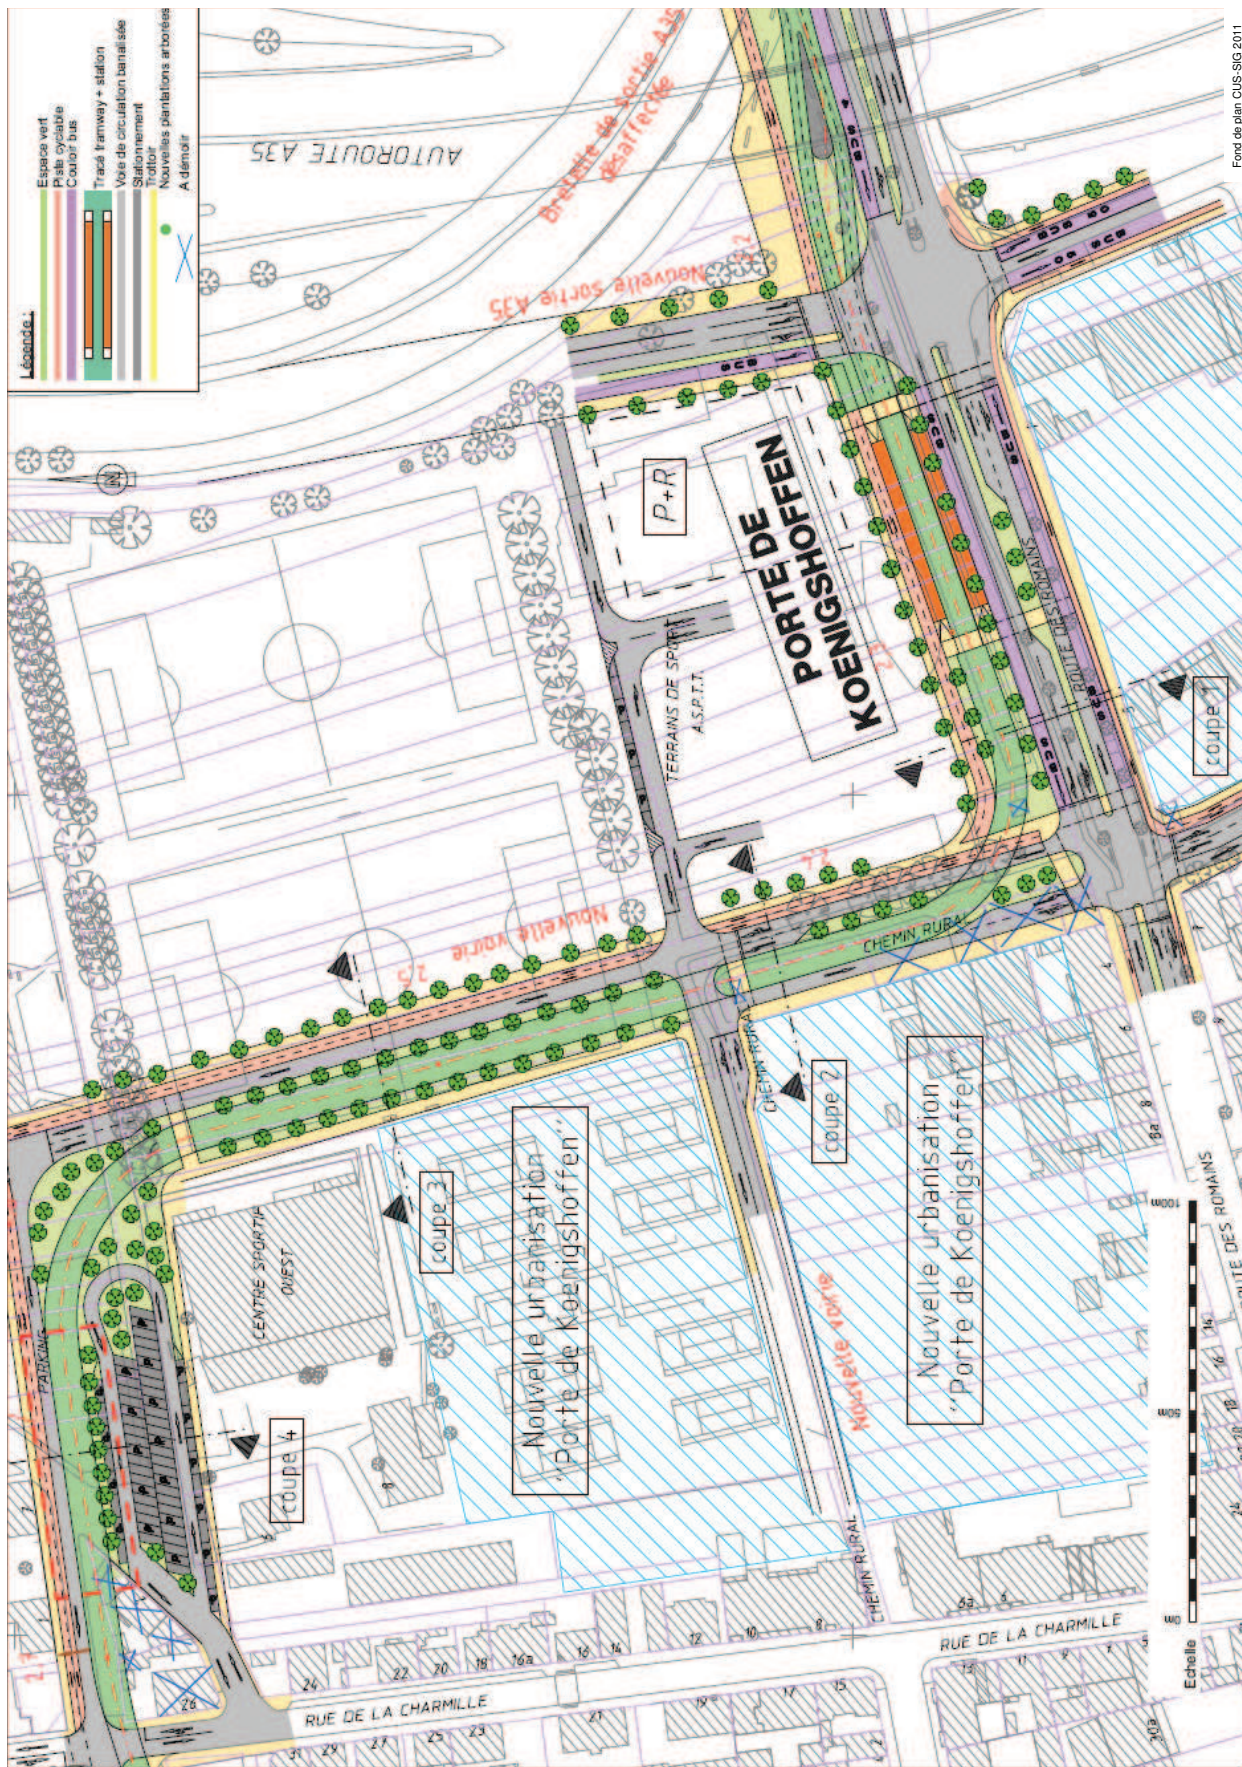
Plan zoom sur secteur "Koenigshoffen / Romans"
